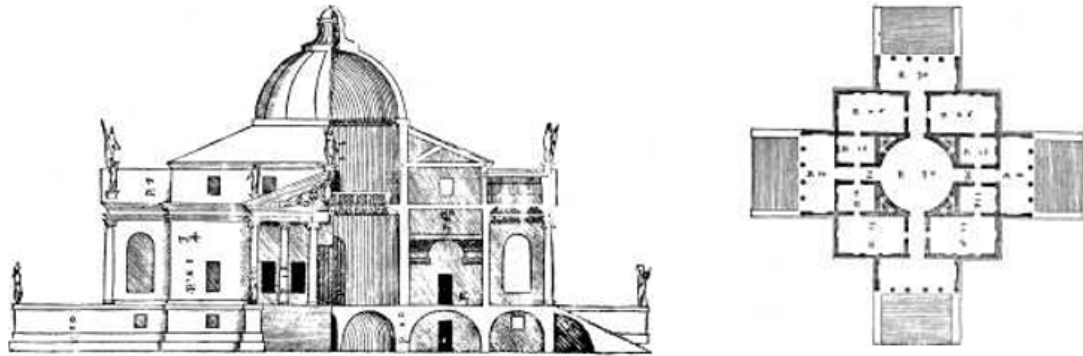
CORTE Y PLANTA DE LA VILLA CAPRA DE 1570 DISEÑADO POR ANDREA PALLADIO
